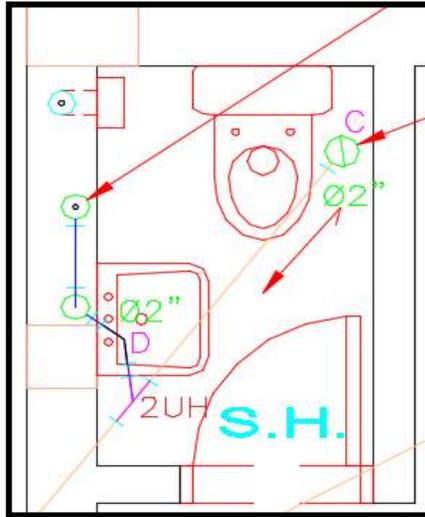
Distribución de descargas en Baño 2, Primer Nivel
